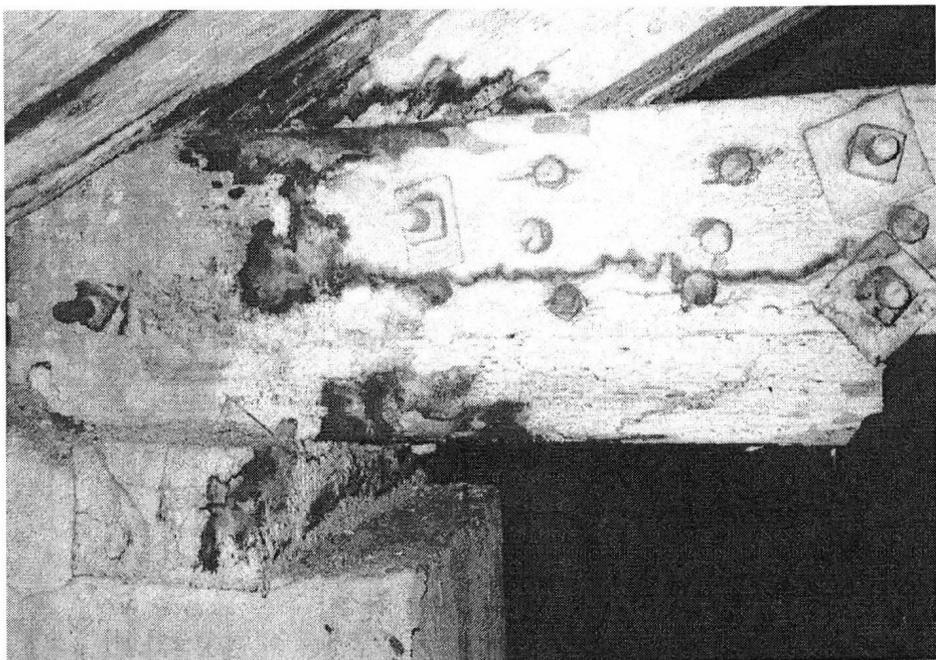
Загнивание опорного узла сегментной фермы (из-за разрушения карнизного участка кровли)
